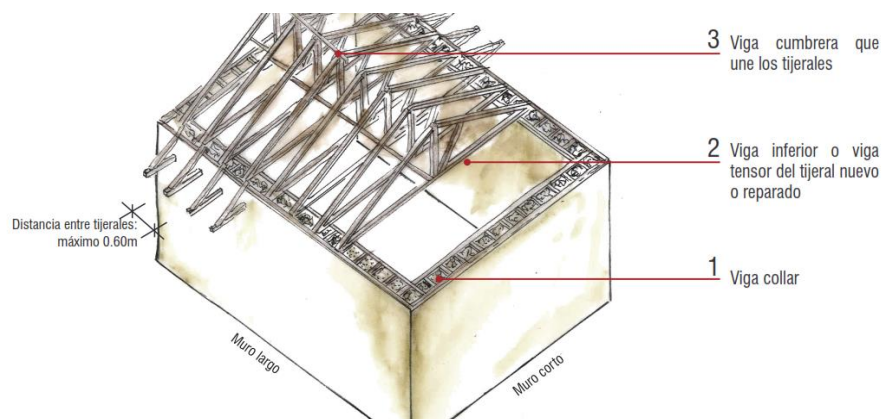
Se propone retirar la cobertura de calamina y cambiar las estructuras de madera por nuevas.
